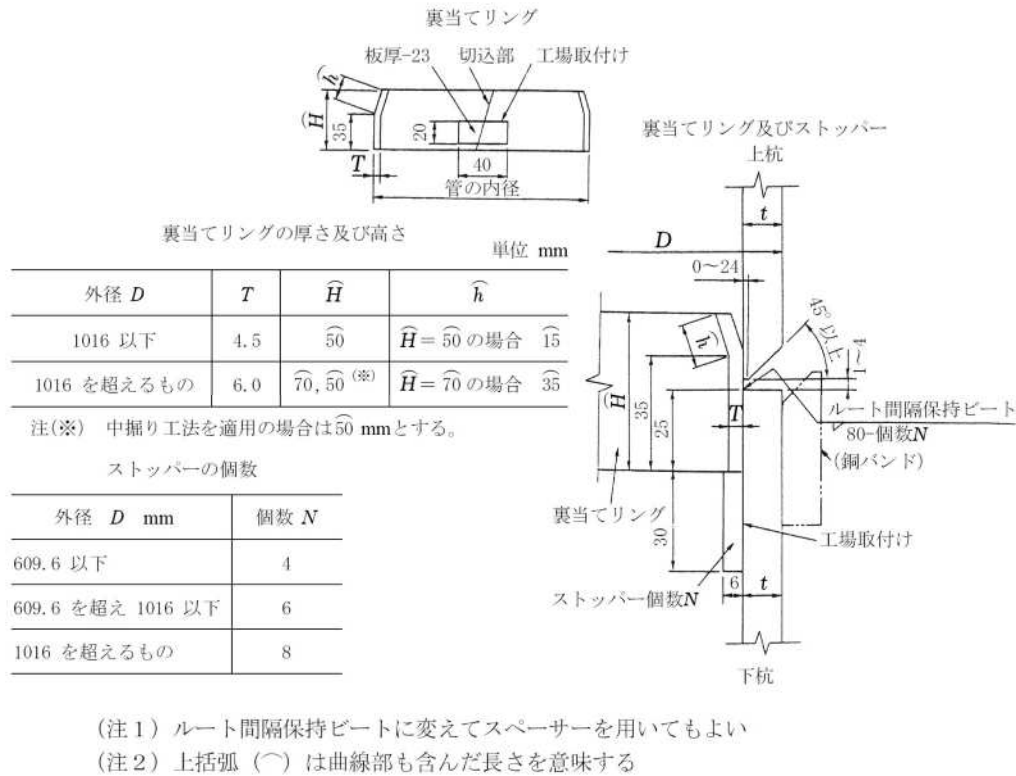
鋼管杭の半自動溶接現場継手標準形状寸法 (道示IV図-解 10.10.2)
